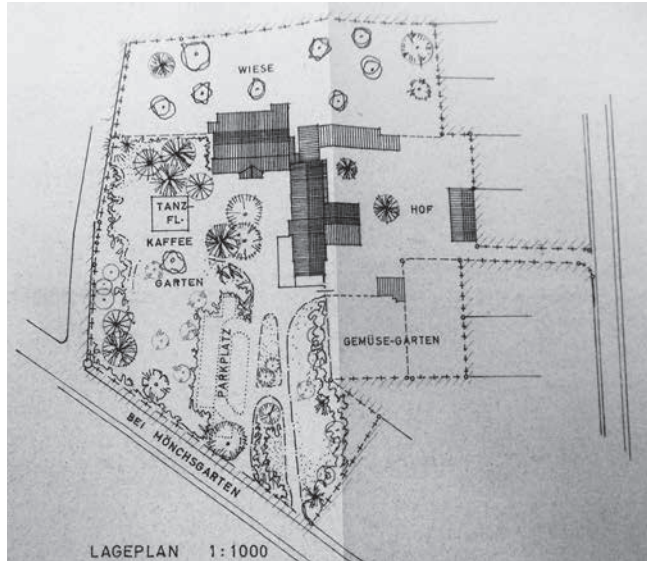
Lageplan, 1958 (StAL-GA 203)
